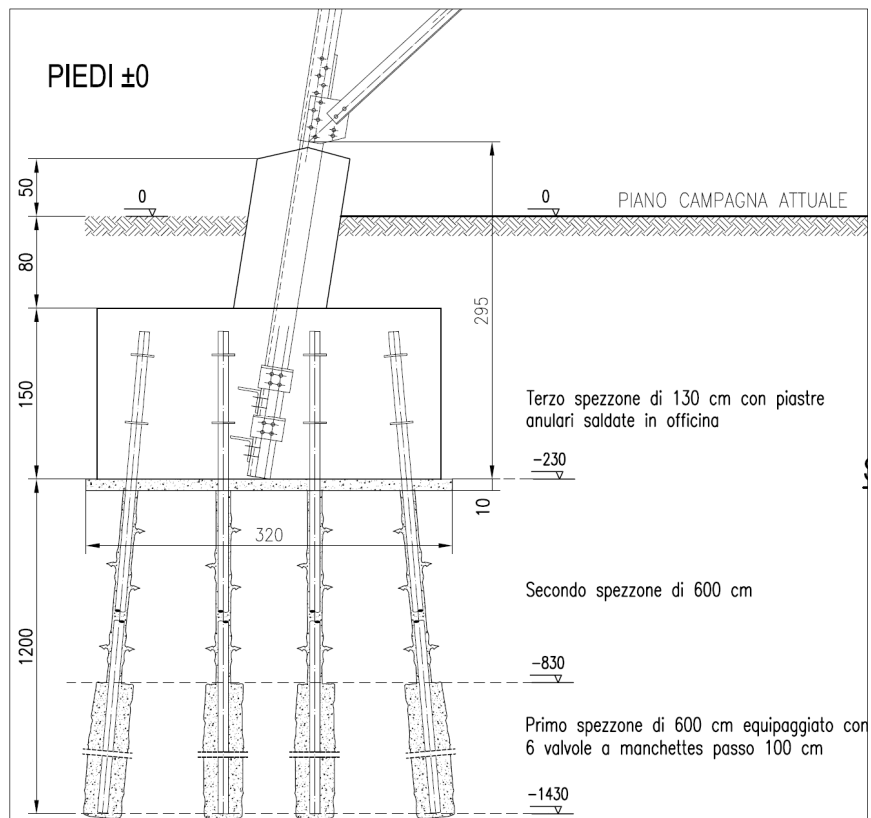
Schema tipo di fondazione profonda su micropali tipo tubfix per sostegni a traliccio.
